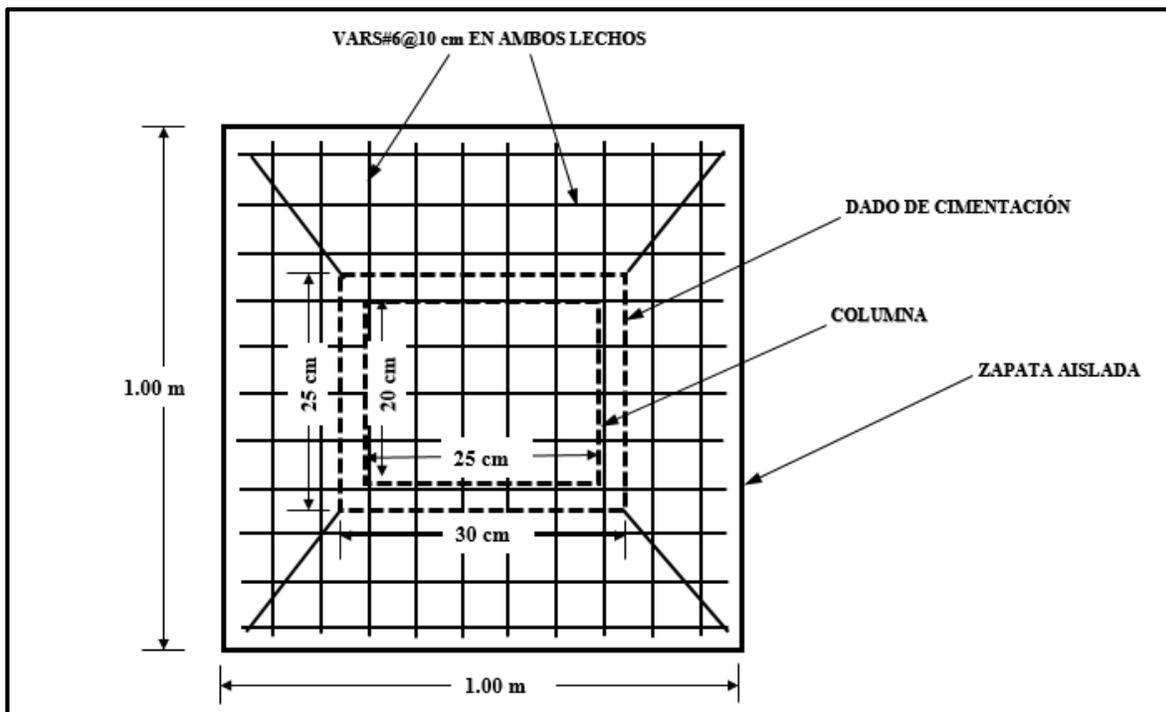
Dimensiones de Zapata Aislada para Cimentación de Estructuras Menores
